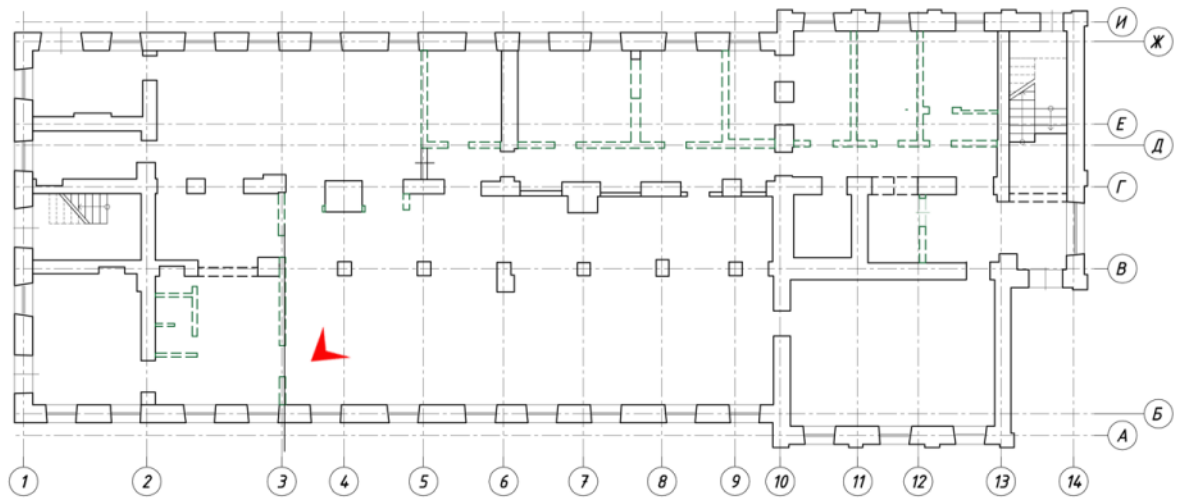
Зальное помещение 1-го этажа в осях 3 – 10/Б – Г.
